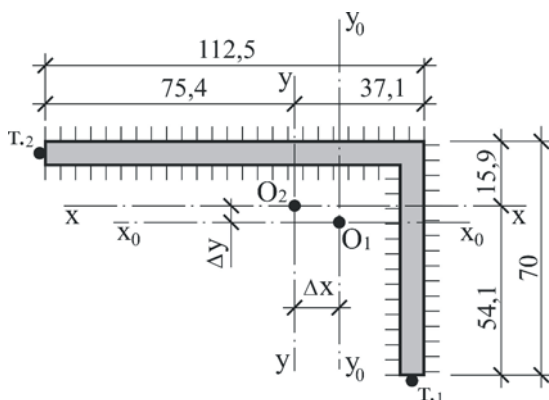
Схема сварного соединения раскоса 18 с поясом фермы
